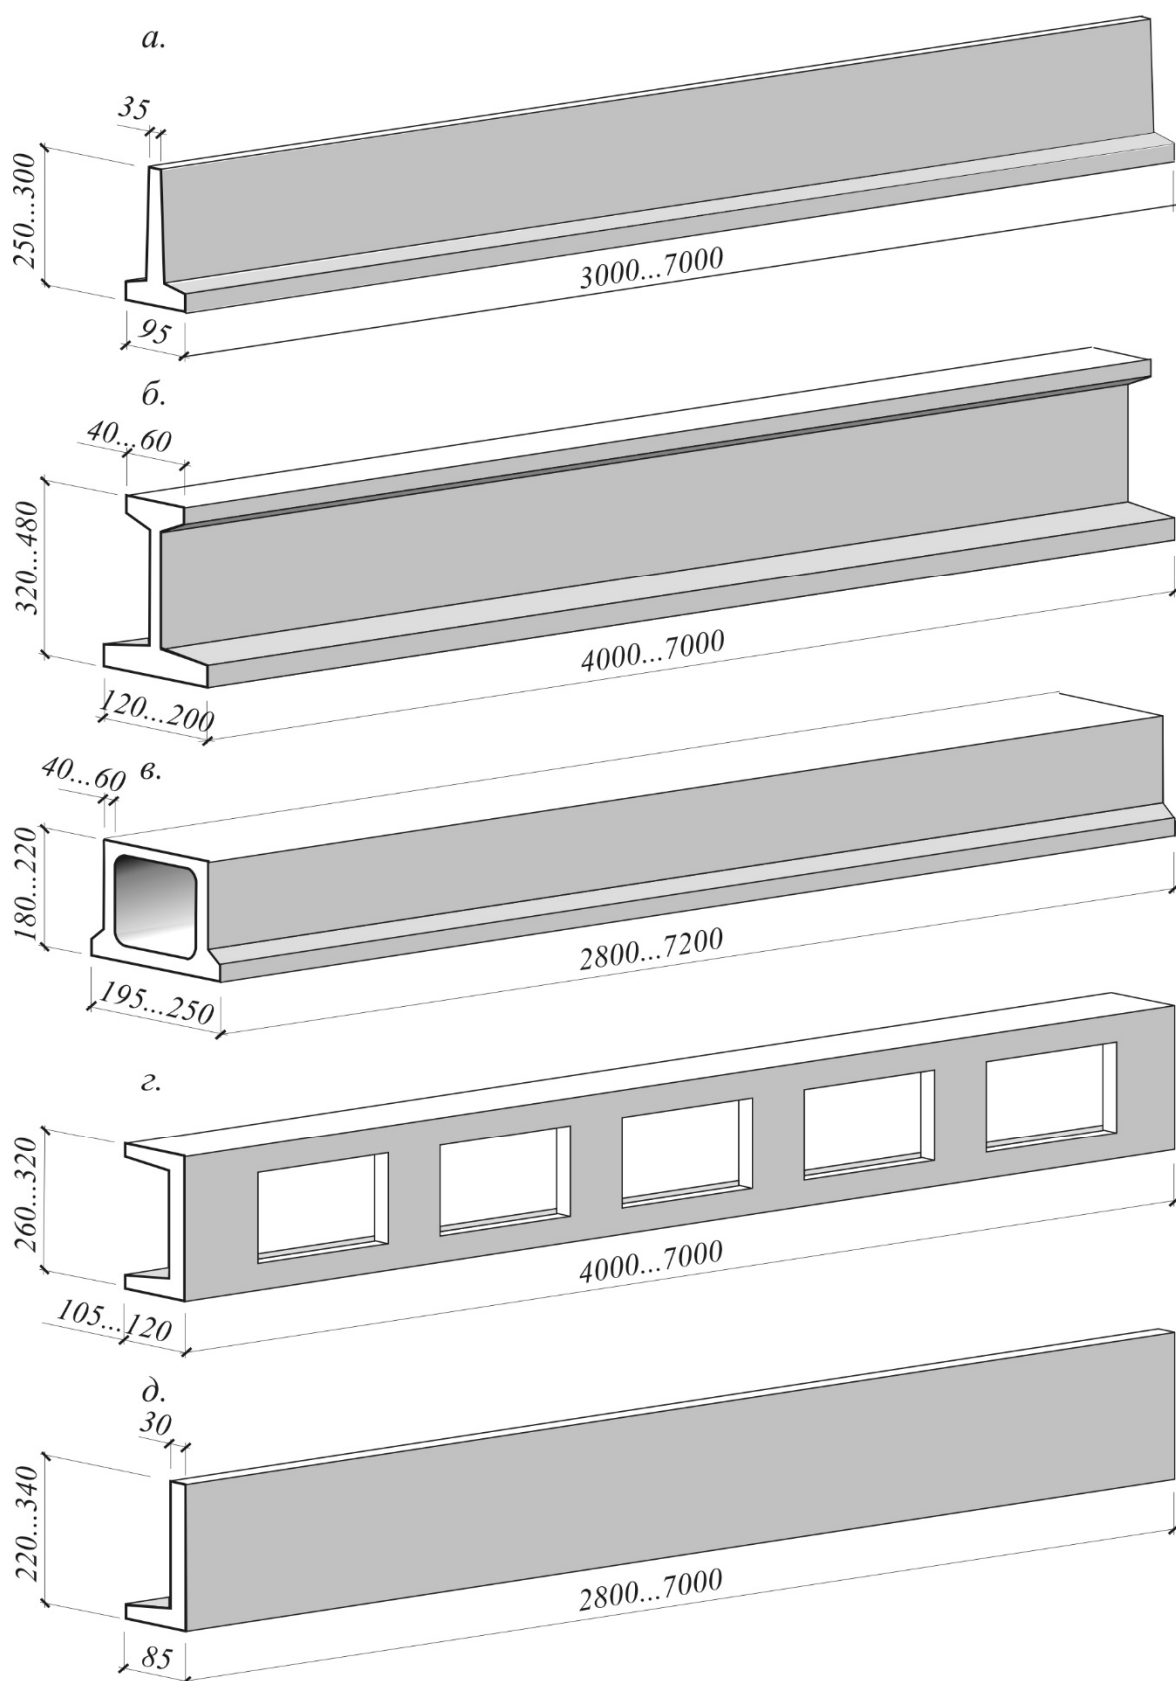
Типы балок, используемые при замене перекрытий:
